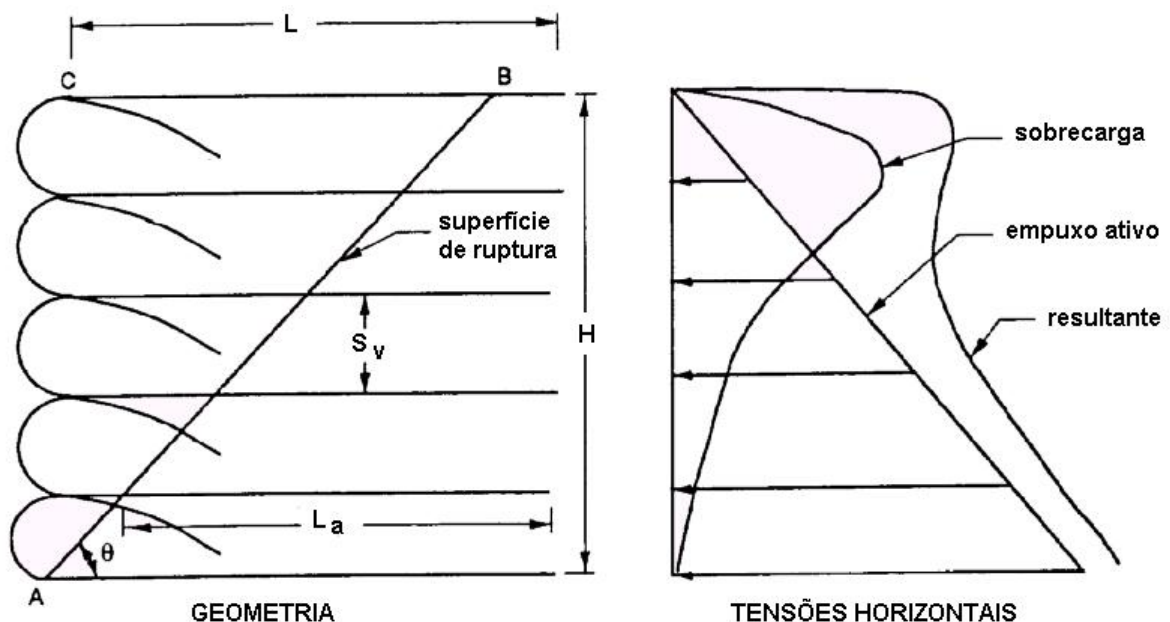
Configuração de um muro de solo reforçado, segundo Steward et al. (1977).
